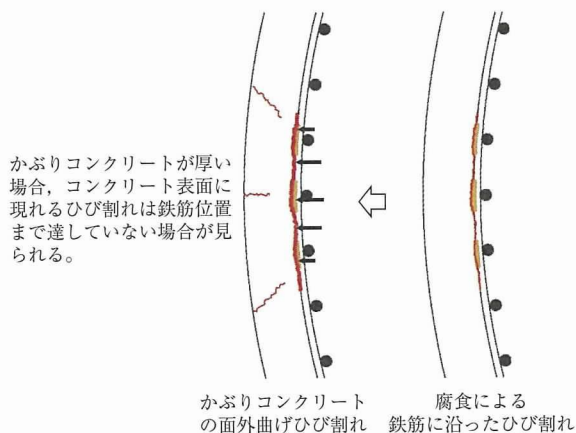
橋脚の鉄筋腐食による浮き、ひび割れ (模式図) 4)
